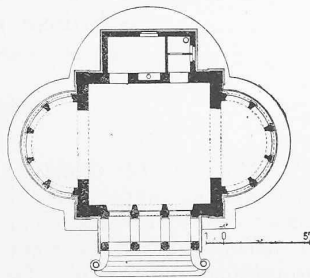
Pavillon de Préfargier. Plan. — Echelle 1 : 400.
